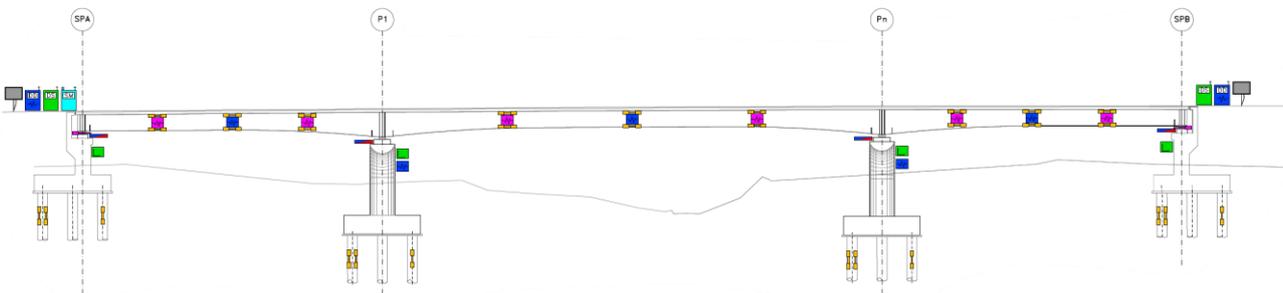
Schema profilo impalcato posizionamento strumentazione
